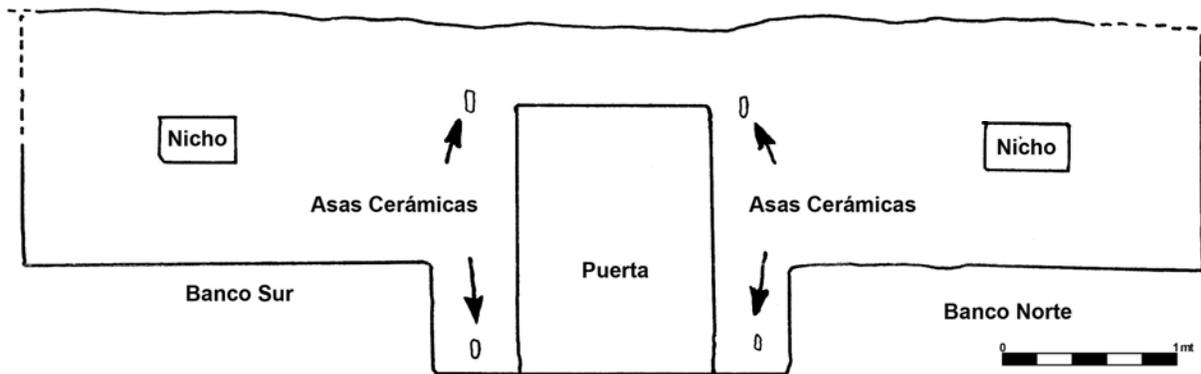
Cerén: elevación de la pared sur de la Estructura 3; nota las ubicaciones de las asas cerámicas (Gerstle 1989)
